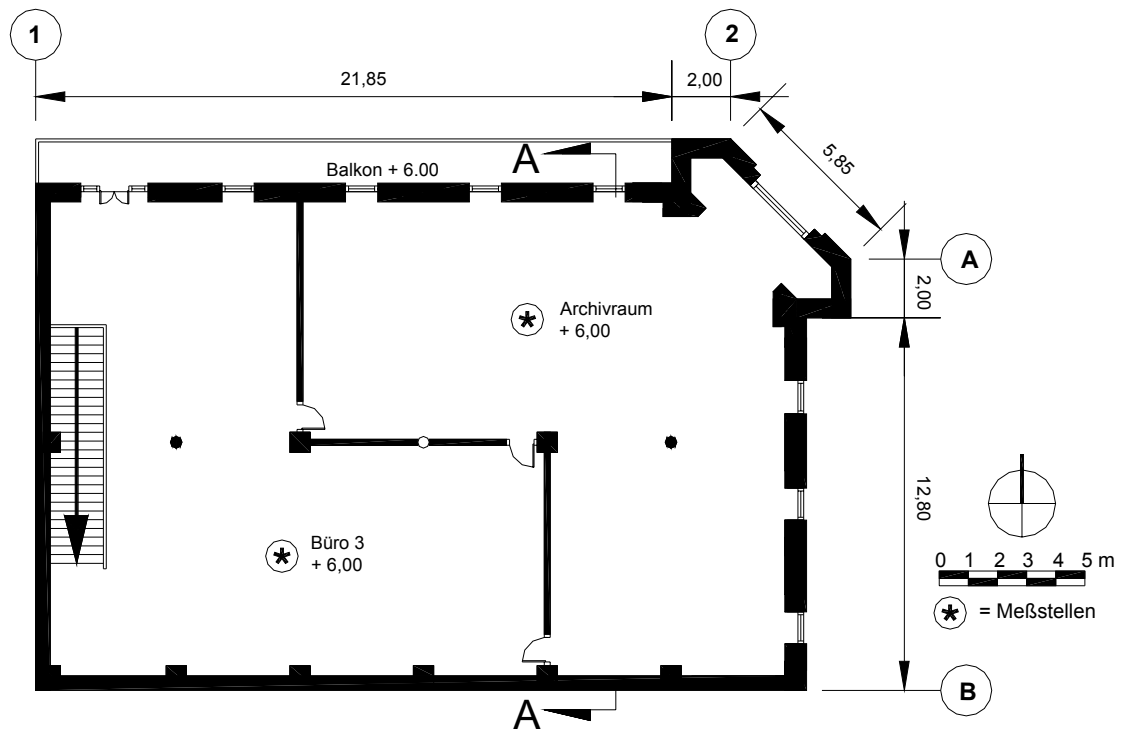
Grundriss 1. Obergeschoss von Gebäude A2
